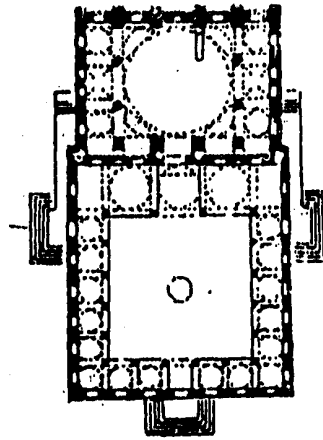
مسقط أفقي لجامع سنان باشا في بشكطاش باستانبول
